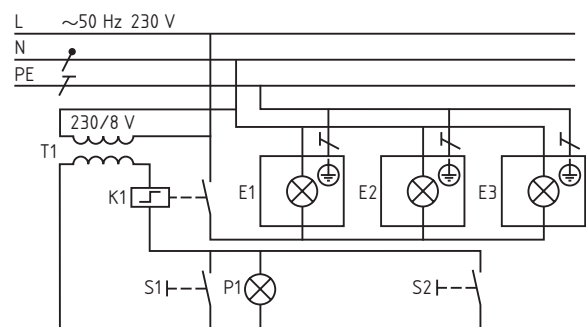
Stromstoßschaltung mit Steuerspannung 8 V, ein Taster beleuchtet
